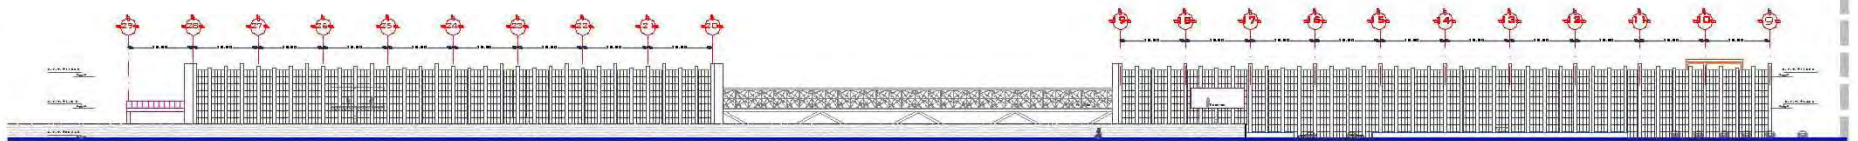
Fachada interior Calzada Ermita Iztapalapa.
